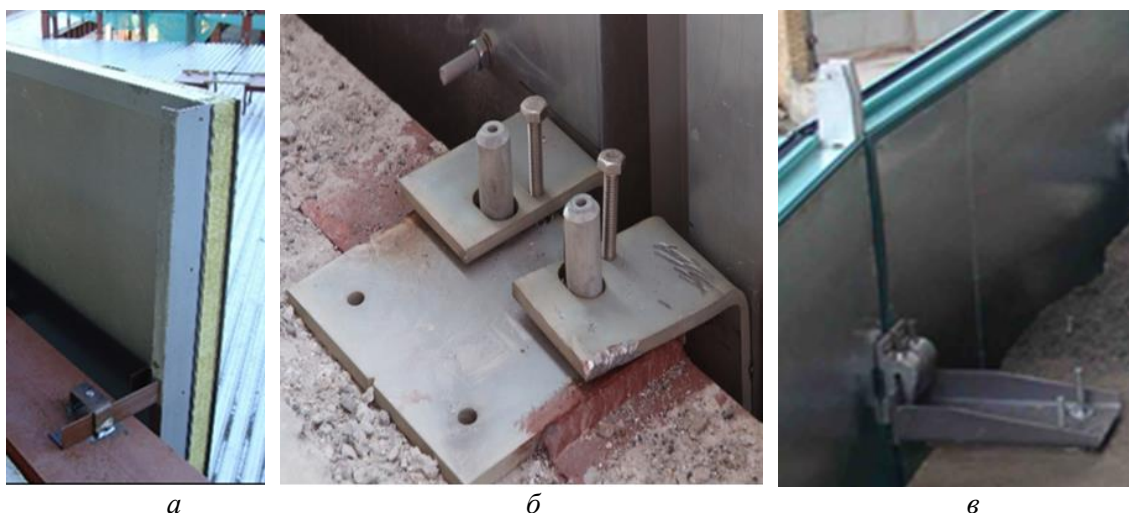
Посадочные кронштейны для монтажа и юстировки фасадных модулей: а – индивидуальные; б, в – парные
